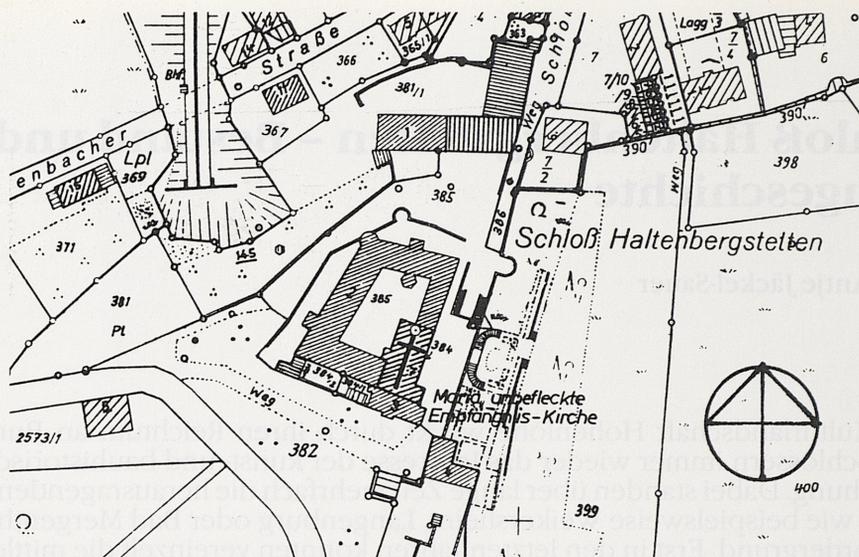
Schloß Haltenbergstetten. Lageplan im Maßstab 1:2500.
